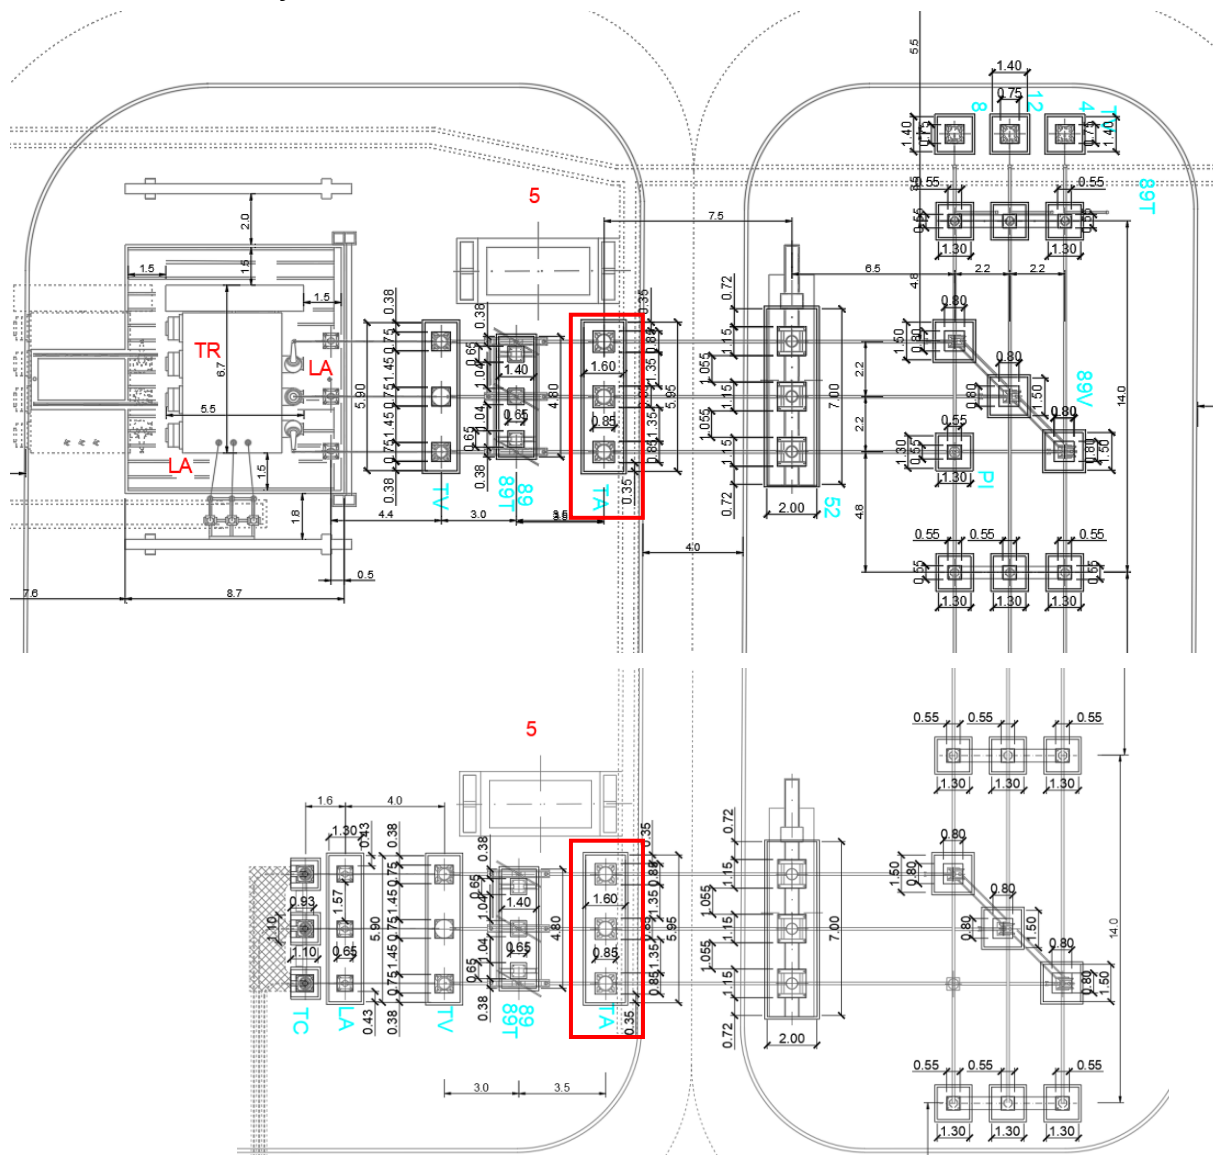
Planimetria degli elementi della sottostazione utente (Nord)
